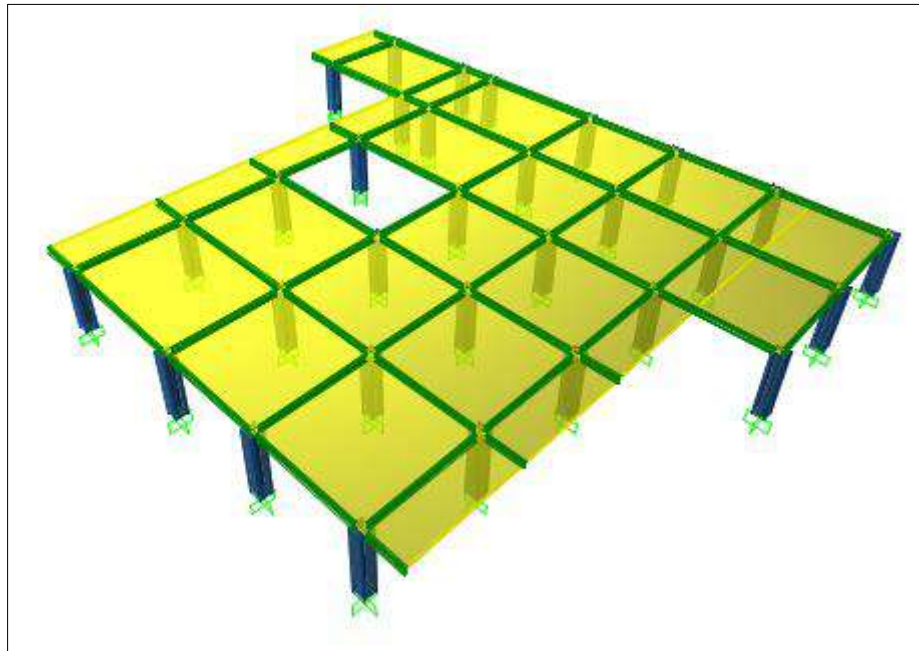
Elementos reforzados (azul) y nuevos (verdes) Estructura 4.2 Torre Occidental
